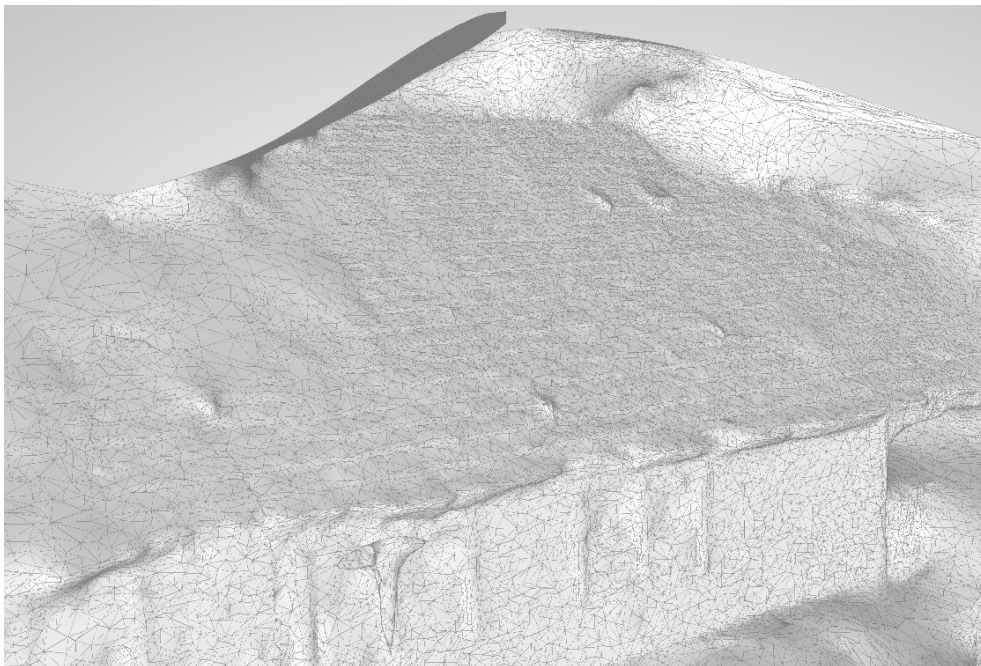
Deformações encontradas em pontos no telhado da edificação.
